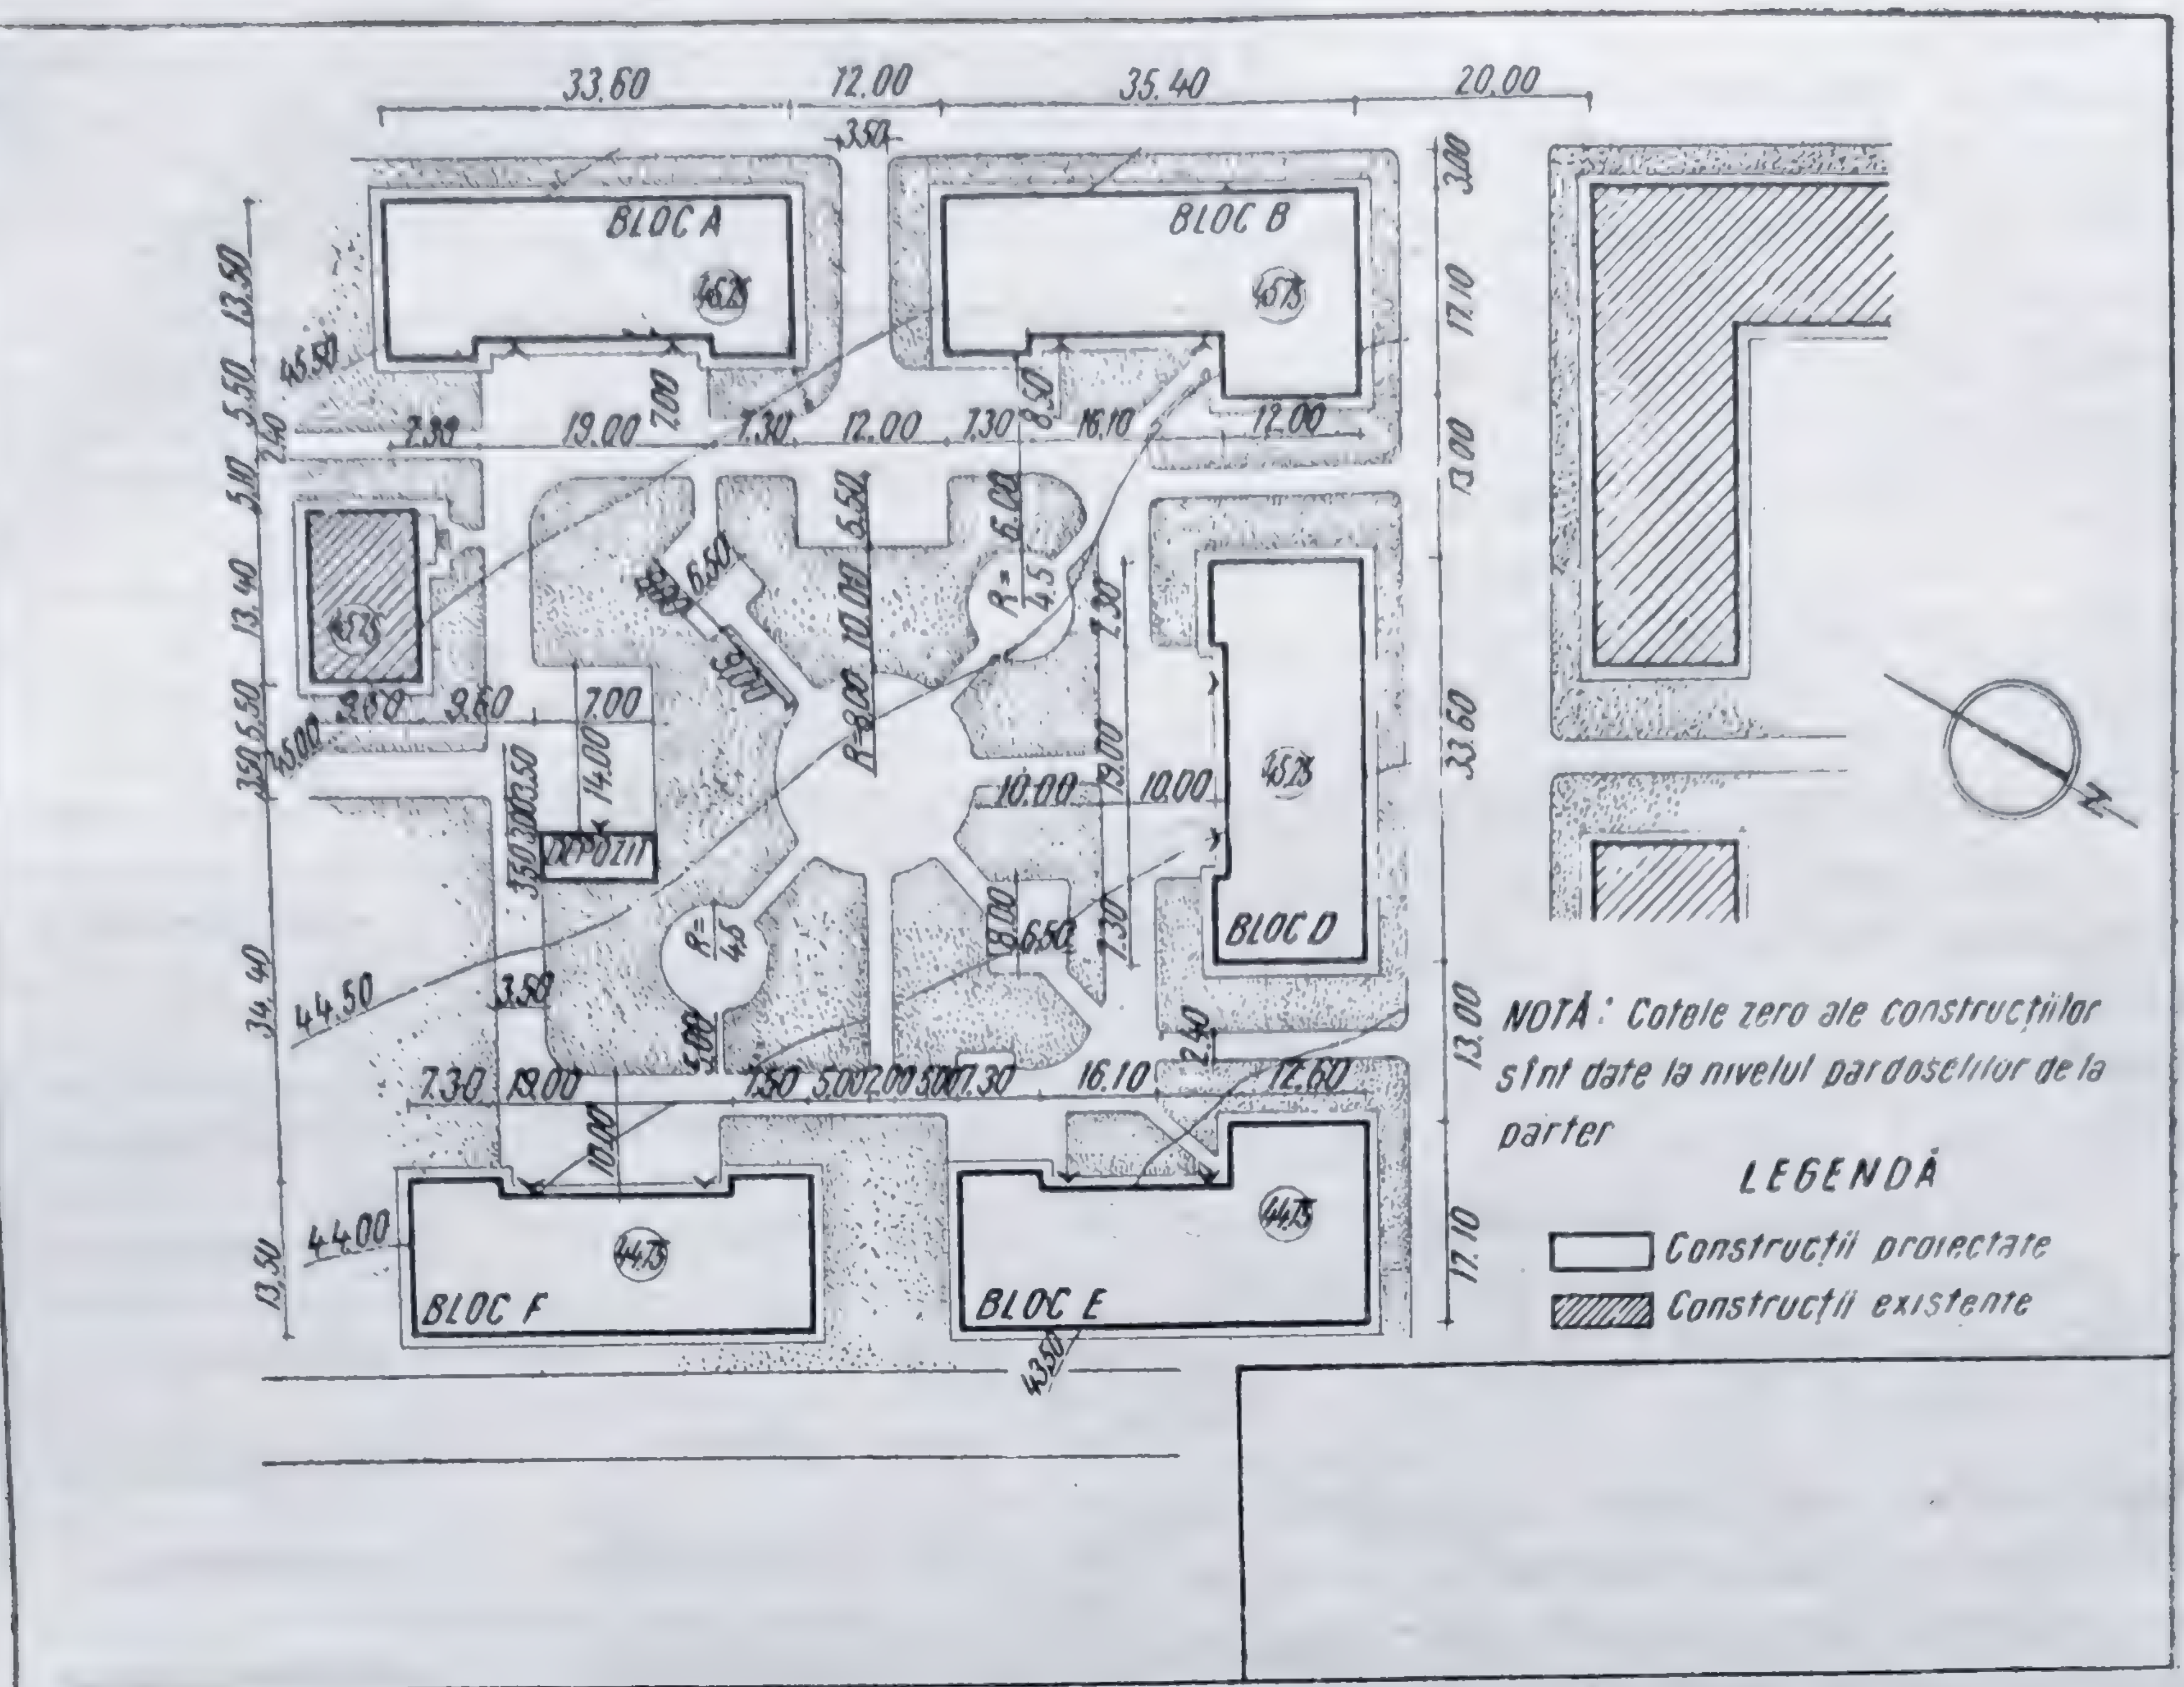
Desen pentru un plan de ansamblu într-o fază avansată de proiectare.
